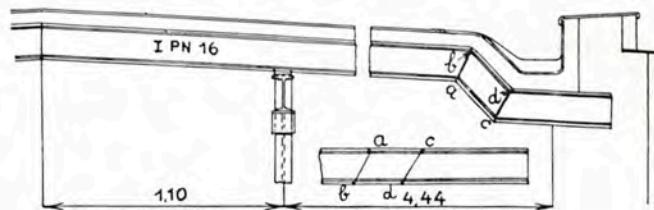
Ferme construite au moyen d'une poutrelle I PN 16, sans aucun déchet de matière.
